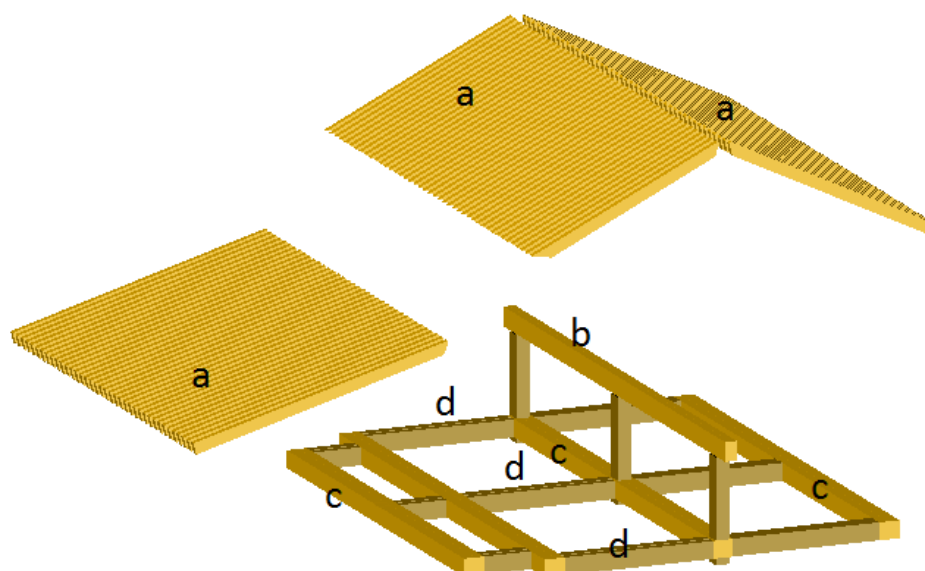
a) Vigueta de techado, b) Viga de cresta o cumbrera, c) Viga lateral, d) Conector de viga.
